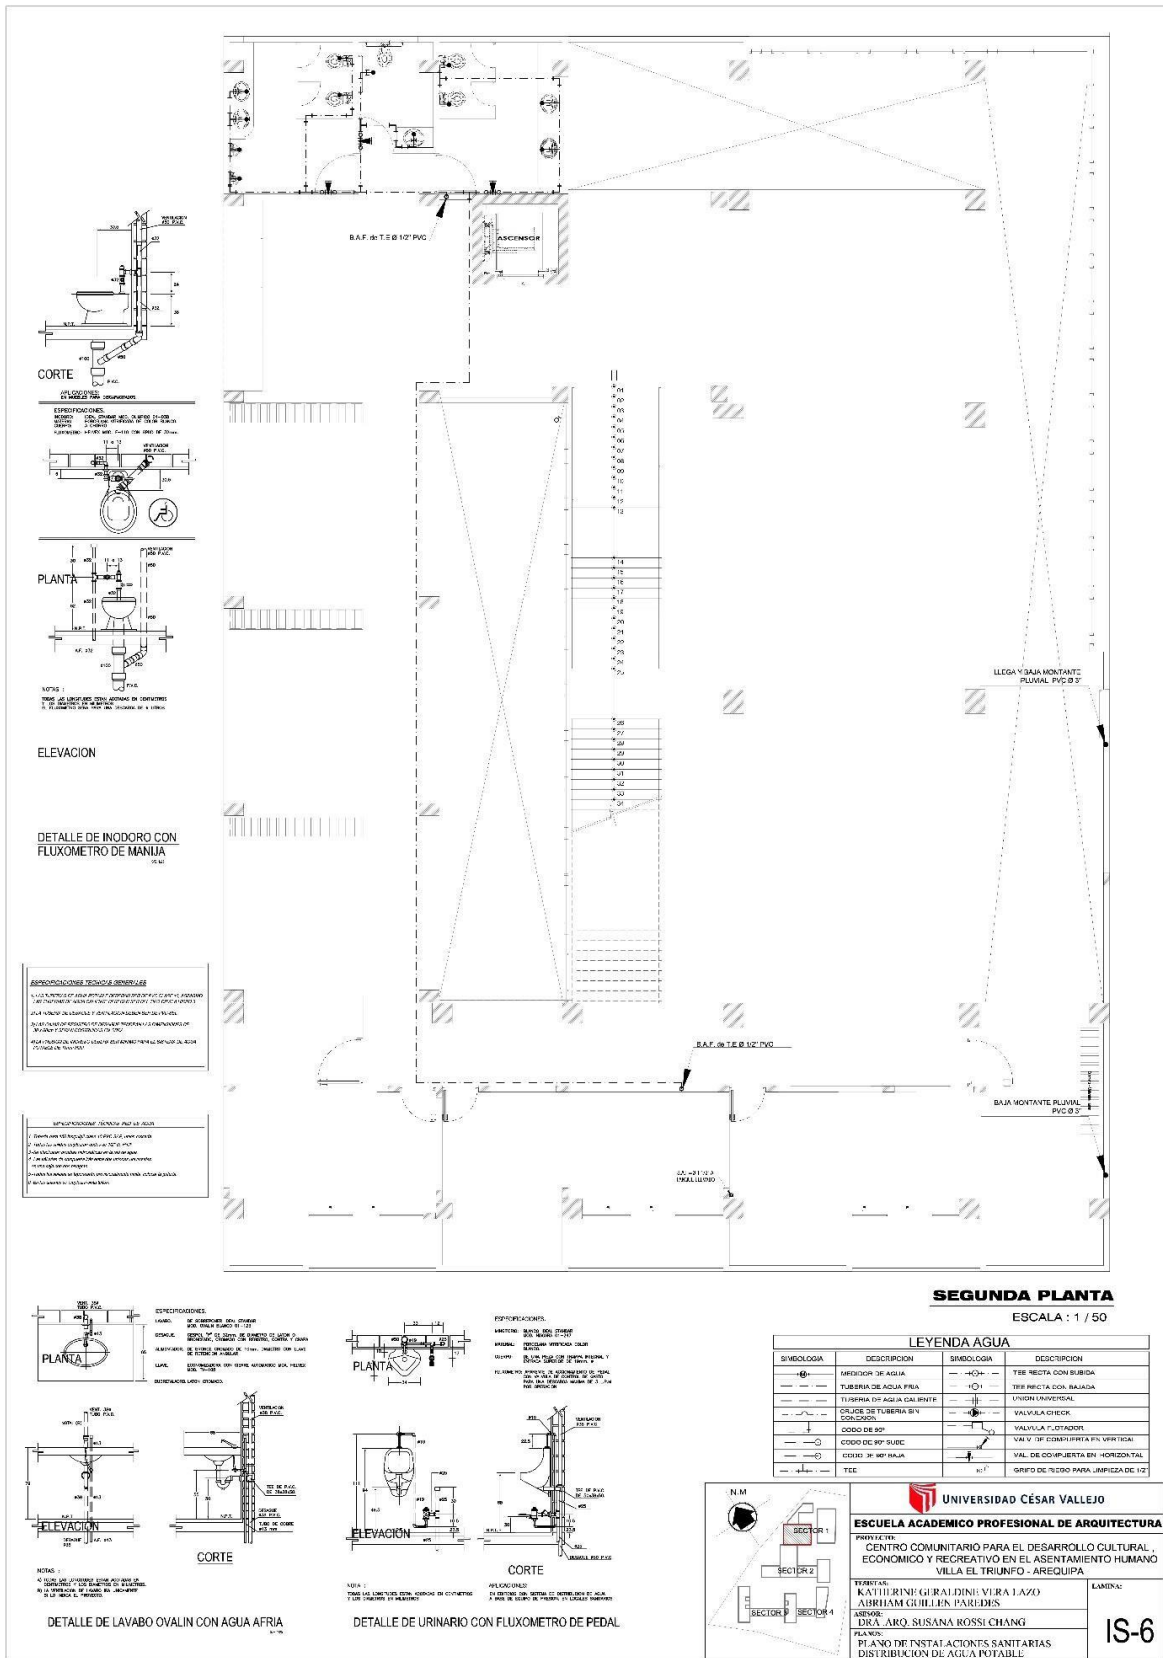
Planos de distribución de redes de agua potable Segunda Planta - Elaboración propia
